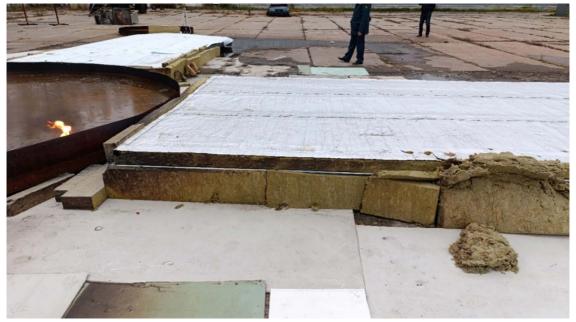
Образец № 4 после испытаний Fig. 12. Sample 4 after testing
